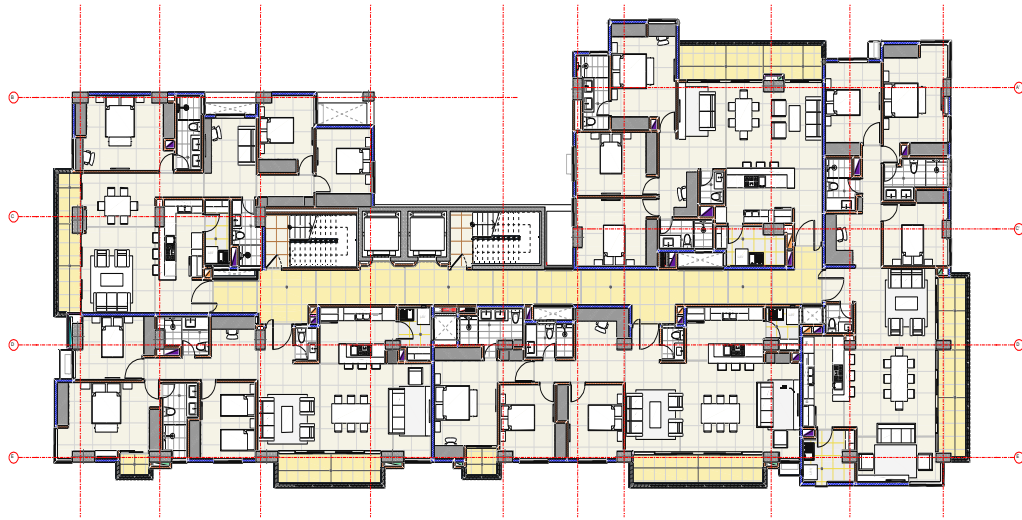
Imágenes publicitarias del proyecto Shantik Casa Boutique (planta tipo y zonas comunes).
